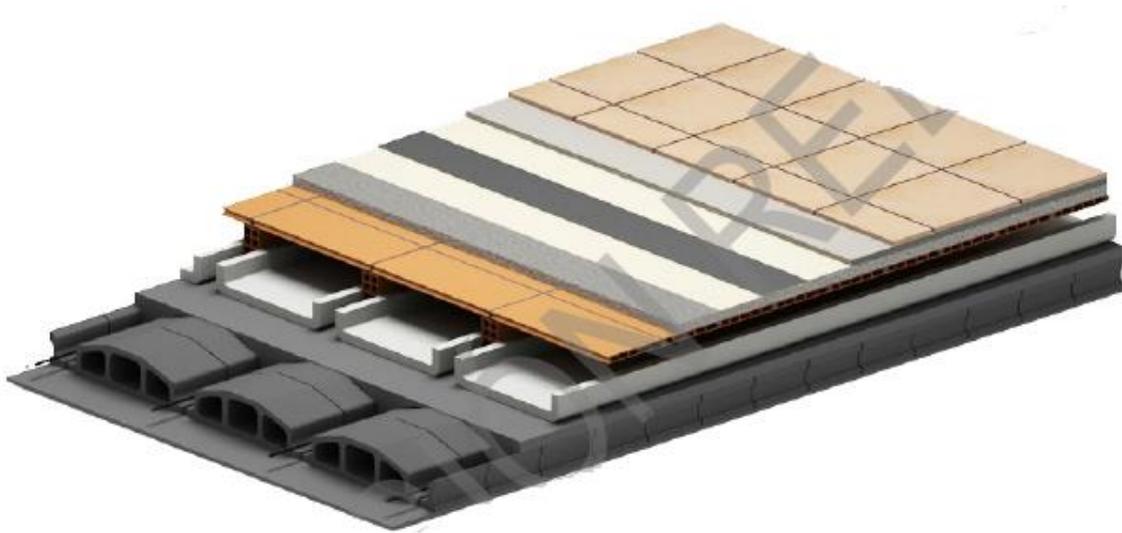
Detalle constructivo de la cubierta con aislamiento por el exterior (Catálogo de sol. de reh. Del IVE).
